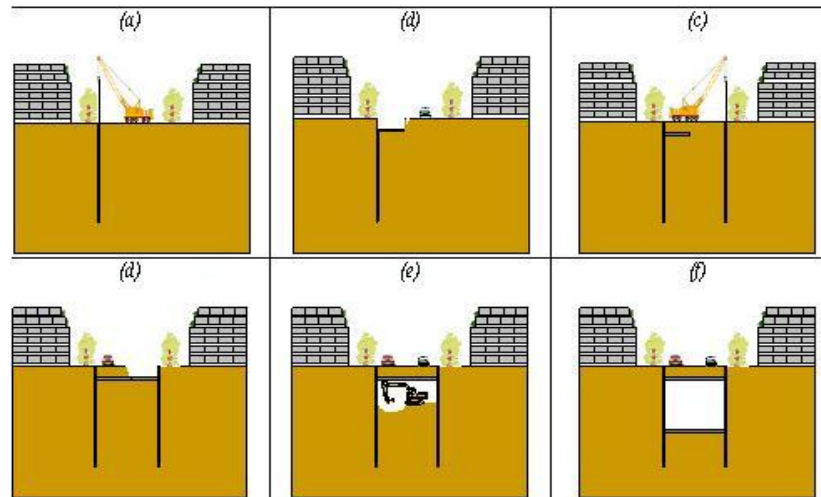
Principe général de la tranchée couverte : (a-b) construction d'un premier mur et d'une moitié de dalle de couverture ; (c-d) construction du second mur et achèvement de la couverture ; (e) terrassements 'en taupes' ; (f) fermeture du cadre.
